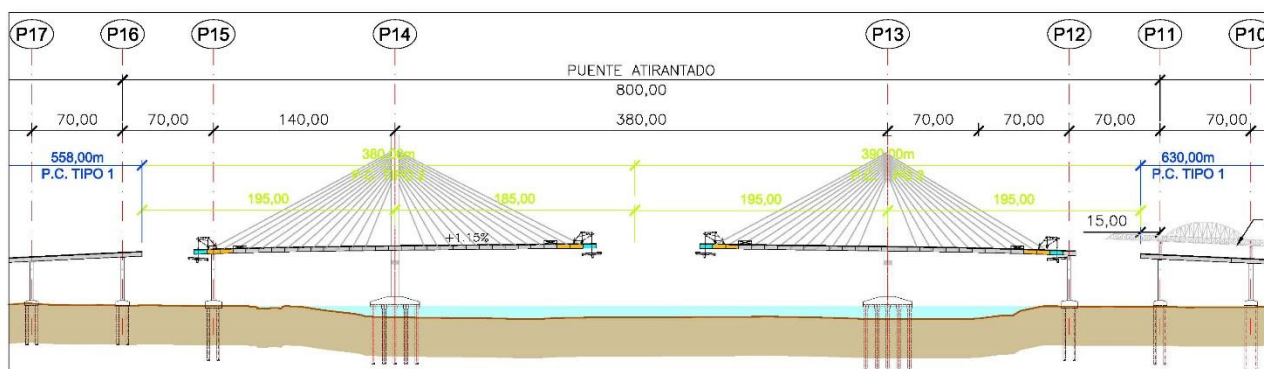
Proceso constructivo del tramo atirantado del Nuevo Puente de Pumarejo
